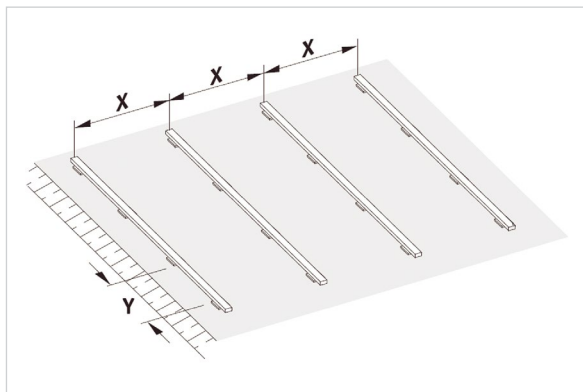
Укладка с резиновыми прокладками на бетонном полу
